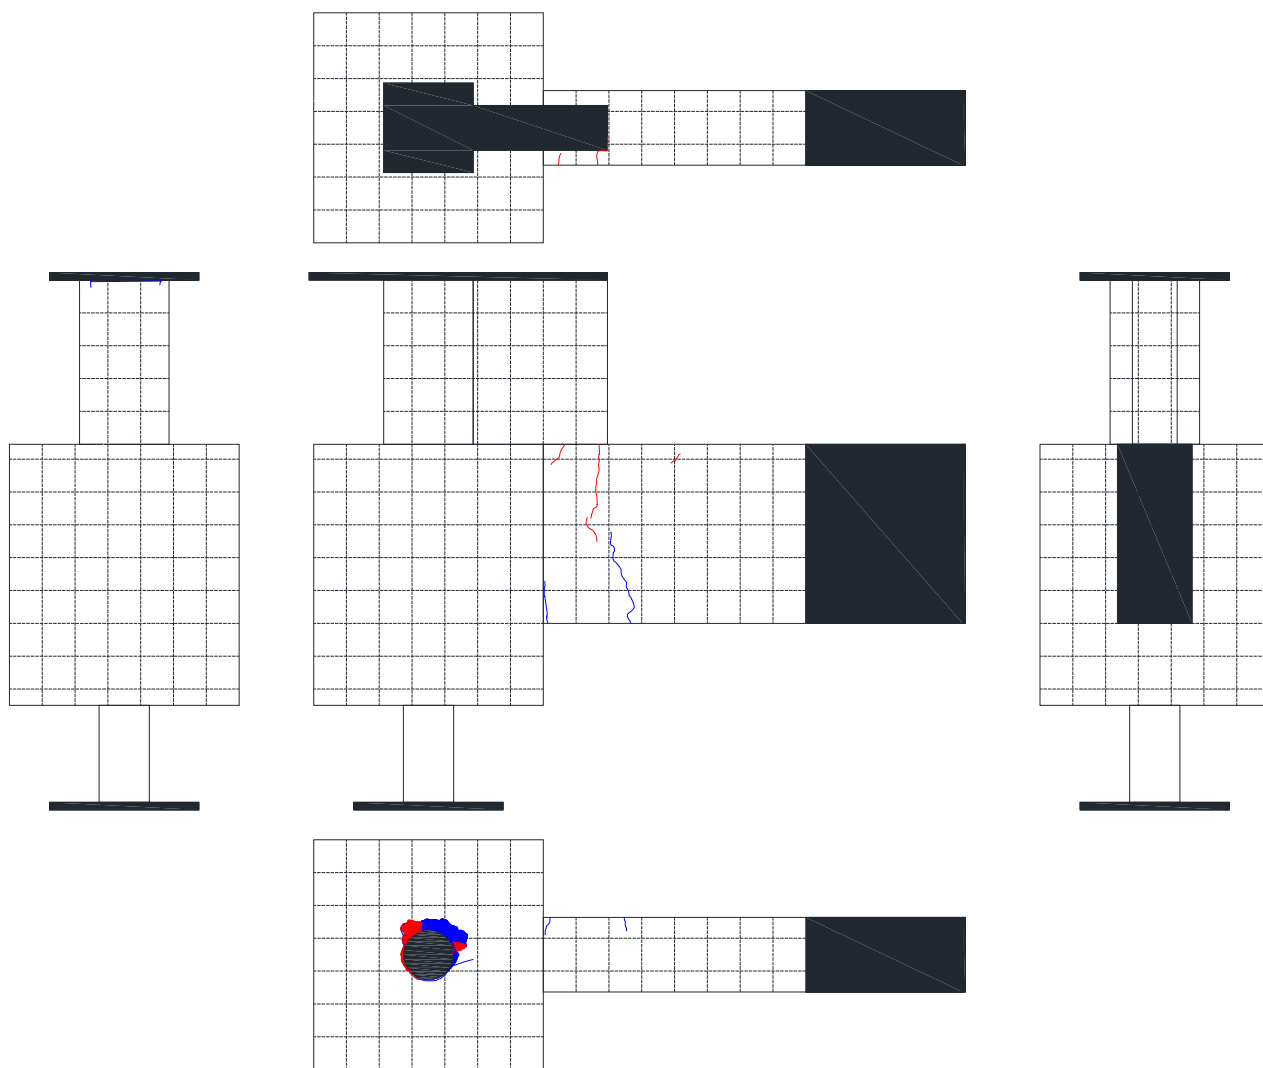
ひび割れ状況 (R=±4.0%サイクル②)
